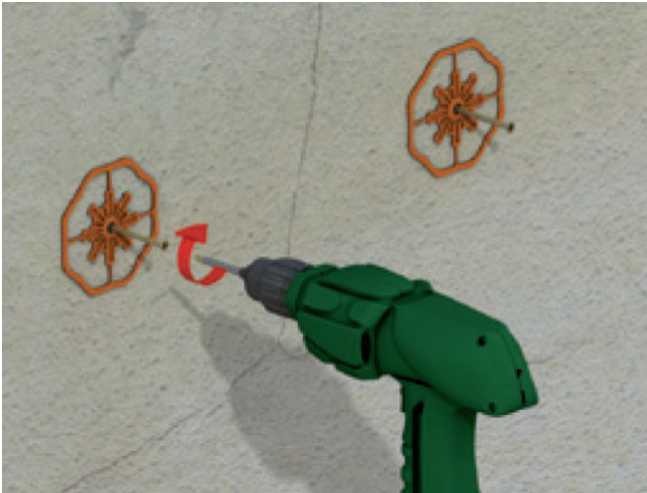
Setzen der Baumit KlebeAnker mittels Bohrschrauber
